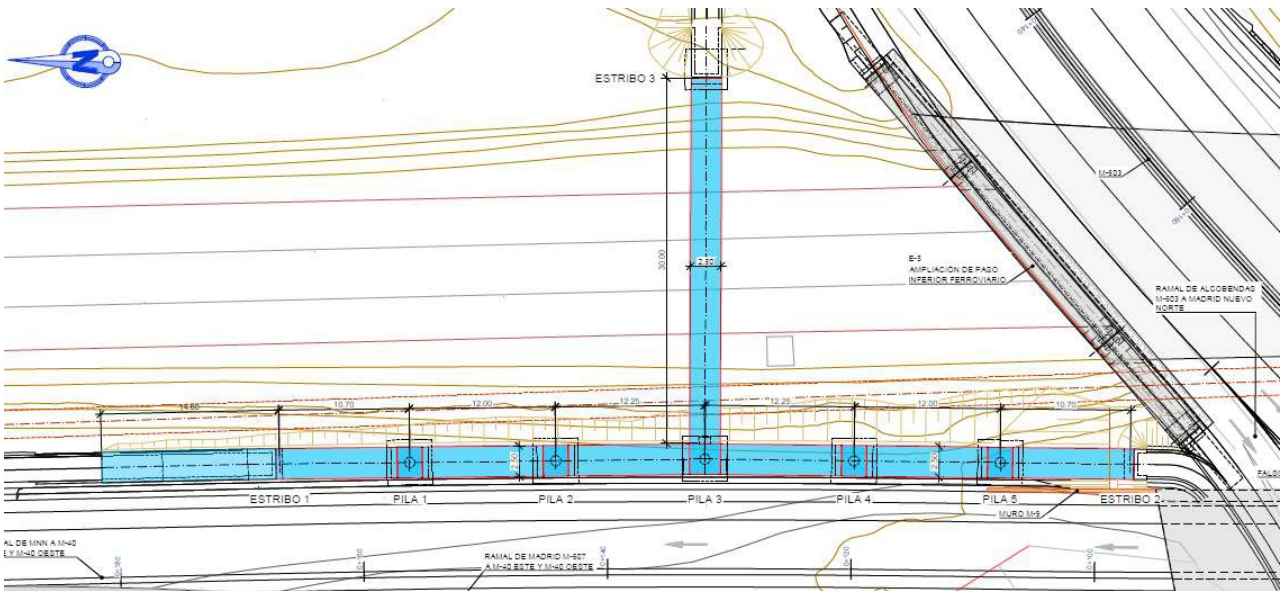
Encaje en planta alternativas 1A, 1B, 3A y 3B. Pasarela P-3
